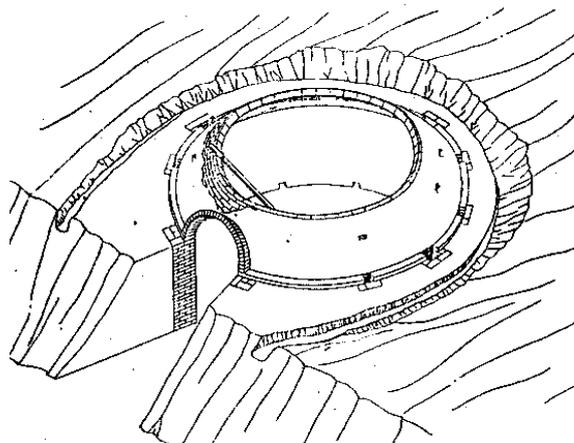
ESQUEMA ILUSTRATIVO DA CONSTRUÇÃO DO FORNO DE BARRANCO DE MINAS GERAIS, COM UM CORTE NA CÚPULA
